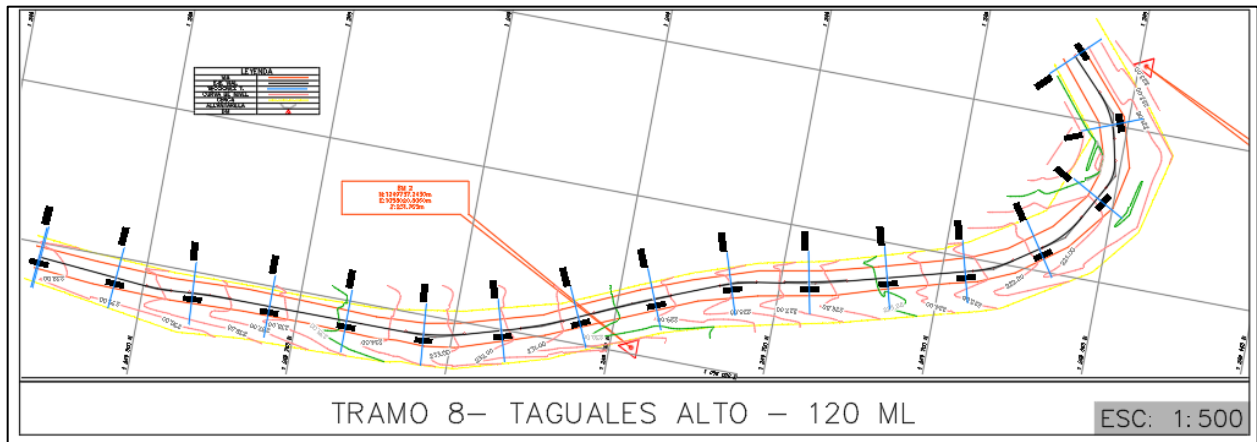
Imagen de planta del tramo 8 del proyecto de San Vicente de Chucuri-Santander
